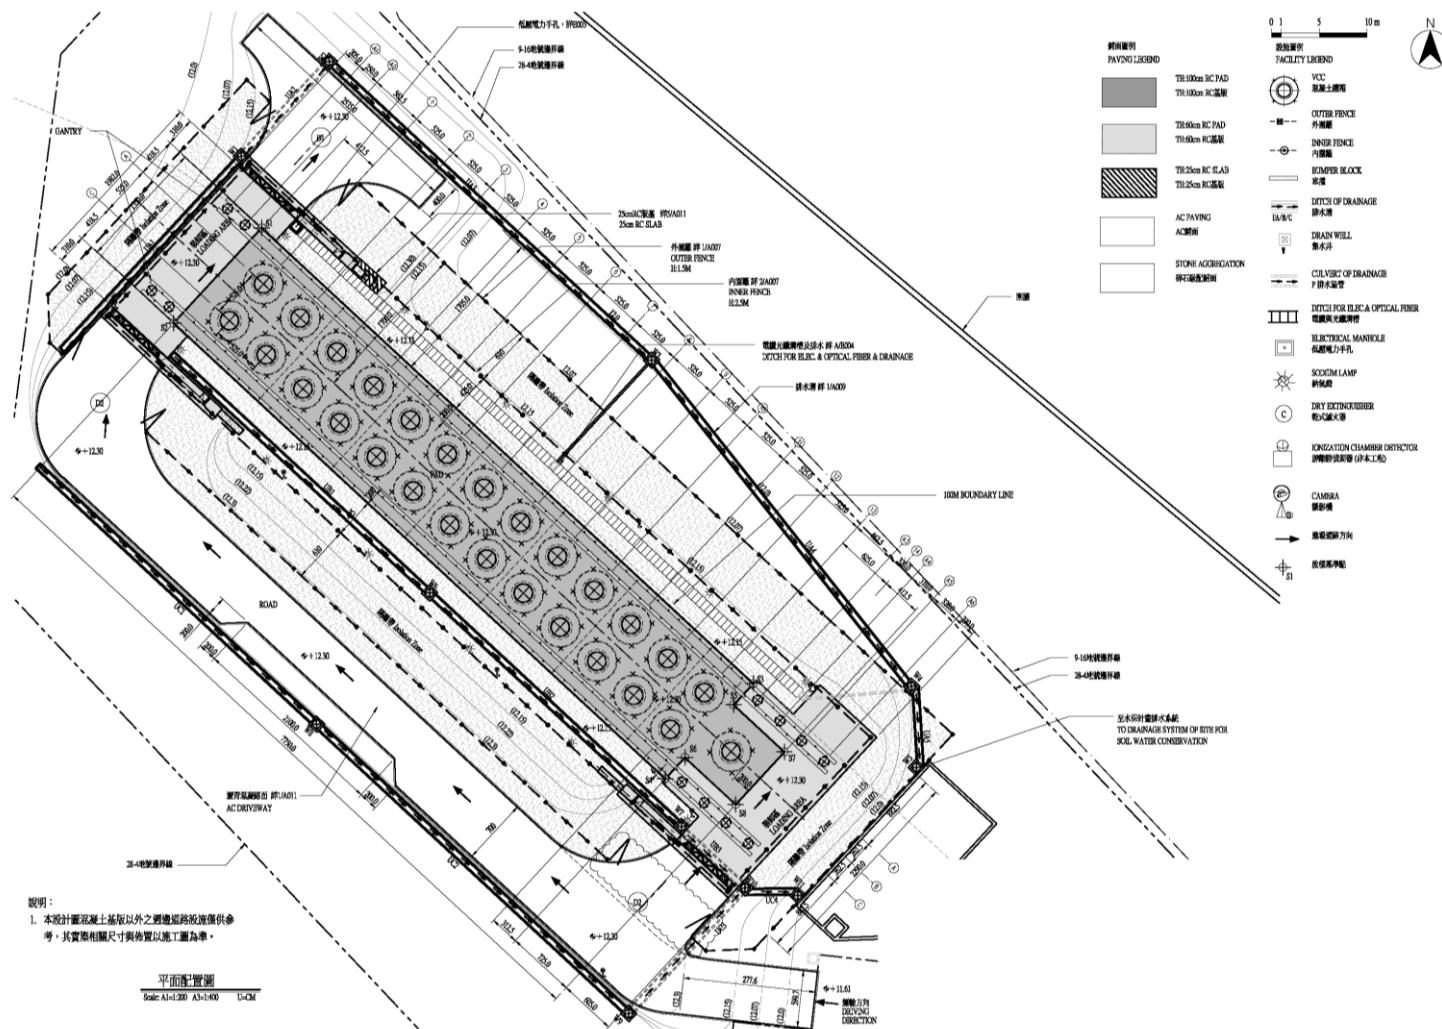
貯存場混凝土基座平面配置圖
